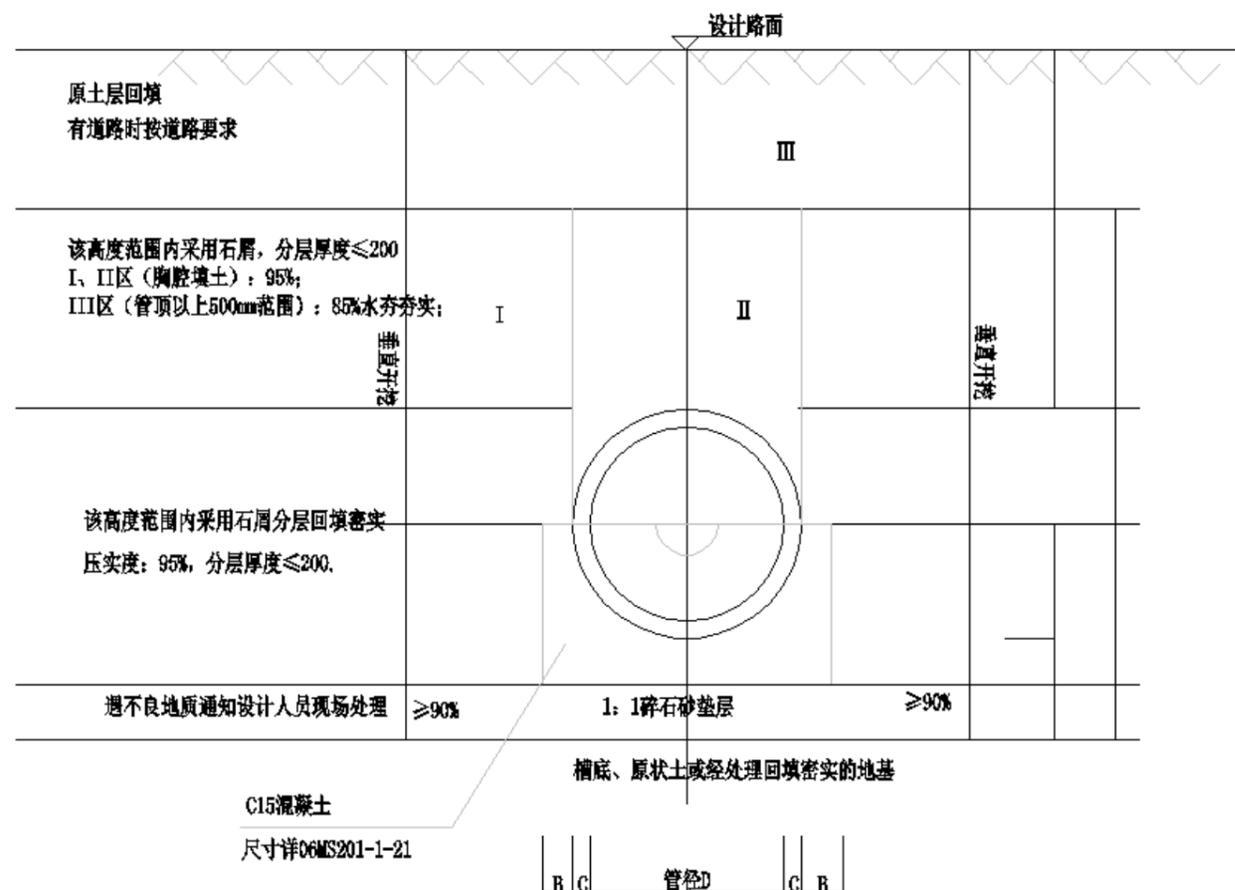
市政道路钢筋砼管混凝土基础及沟槽开挖回填图
